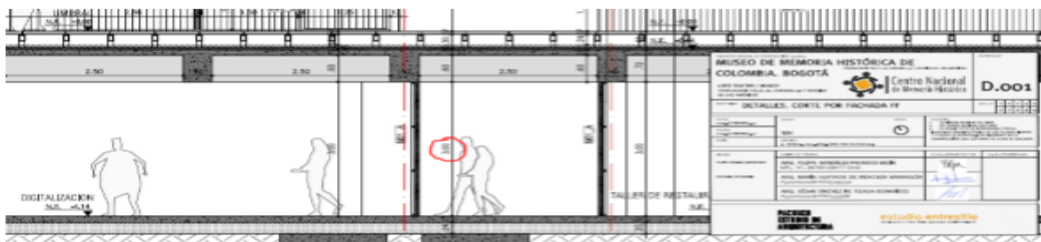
Extracto de la vista del corte por fachada arquitectónico del sótano 1.
